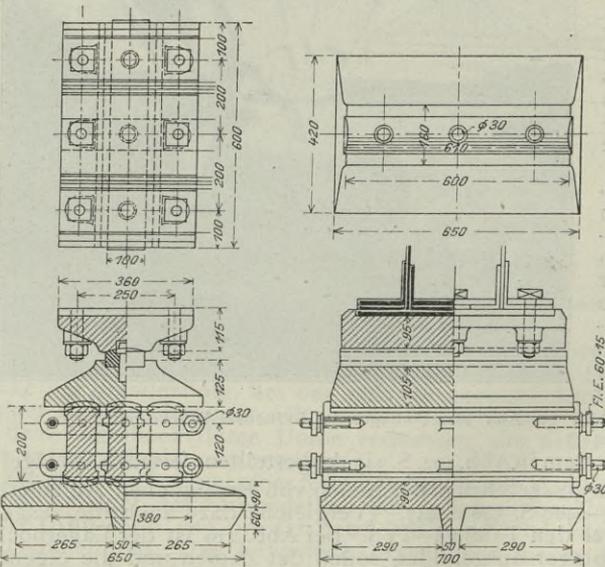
Bewegliches Lager der Havelbrücke bei Brandenburg.
